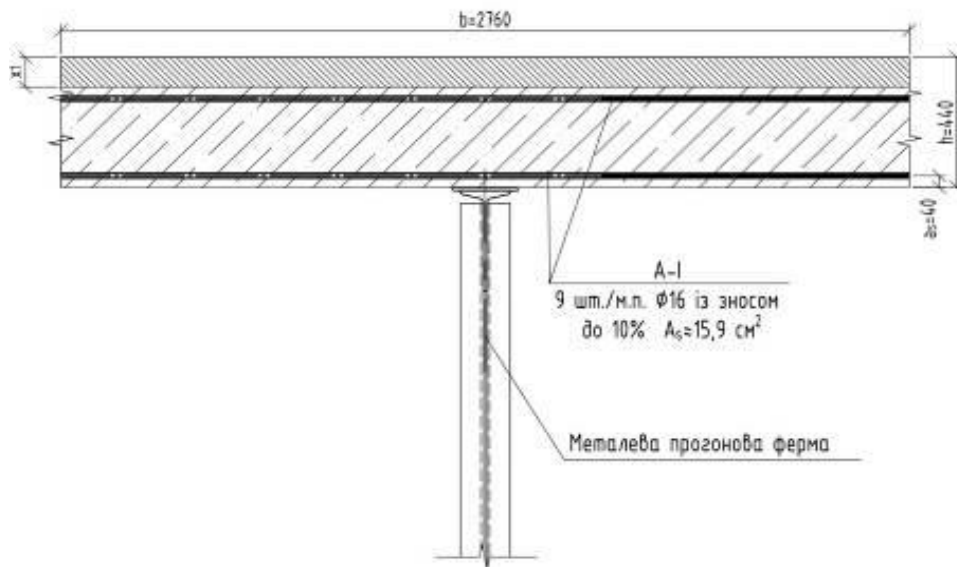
Переріз і армування фрагмента сталезалізобетонної конструкції мосту
